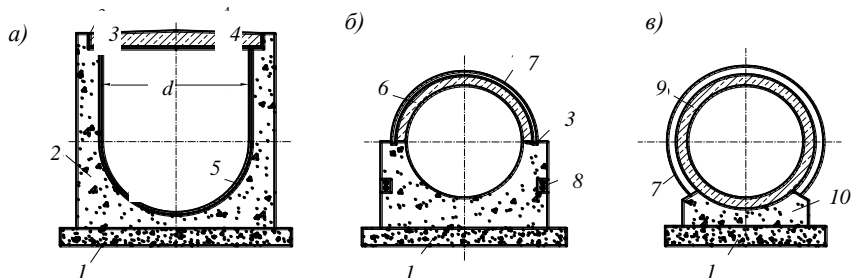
Коллекторы, выполненные при открытом способе строительства: *а* – полукруглой формы; *б* – круглой формы (комбинированный); *в* – круглой формы из труб; 1 – подготовка; 2 – бетонное основание; 3 – битум; 4 – железобетонная плита; 5 – штукатурка; 6 – свод; 7 – бетонный пояс заделки стыков; 8 – железобетонный пояс крепления блоков оснований; 9 – железобетонная труба; 10 – бетонный стул
